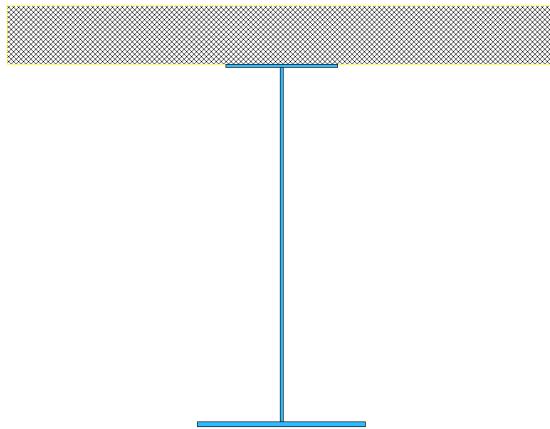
Geometria generica della sezione mista acciaio-calcestruzzo
